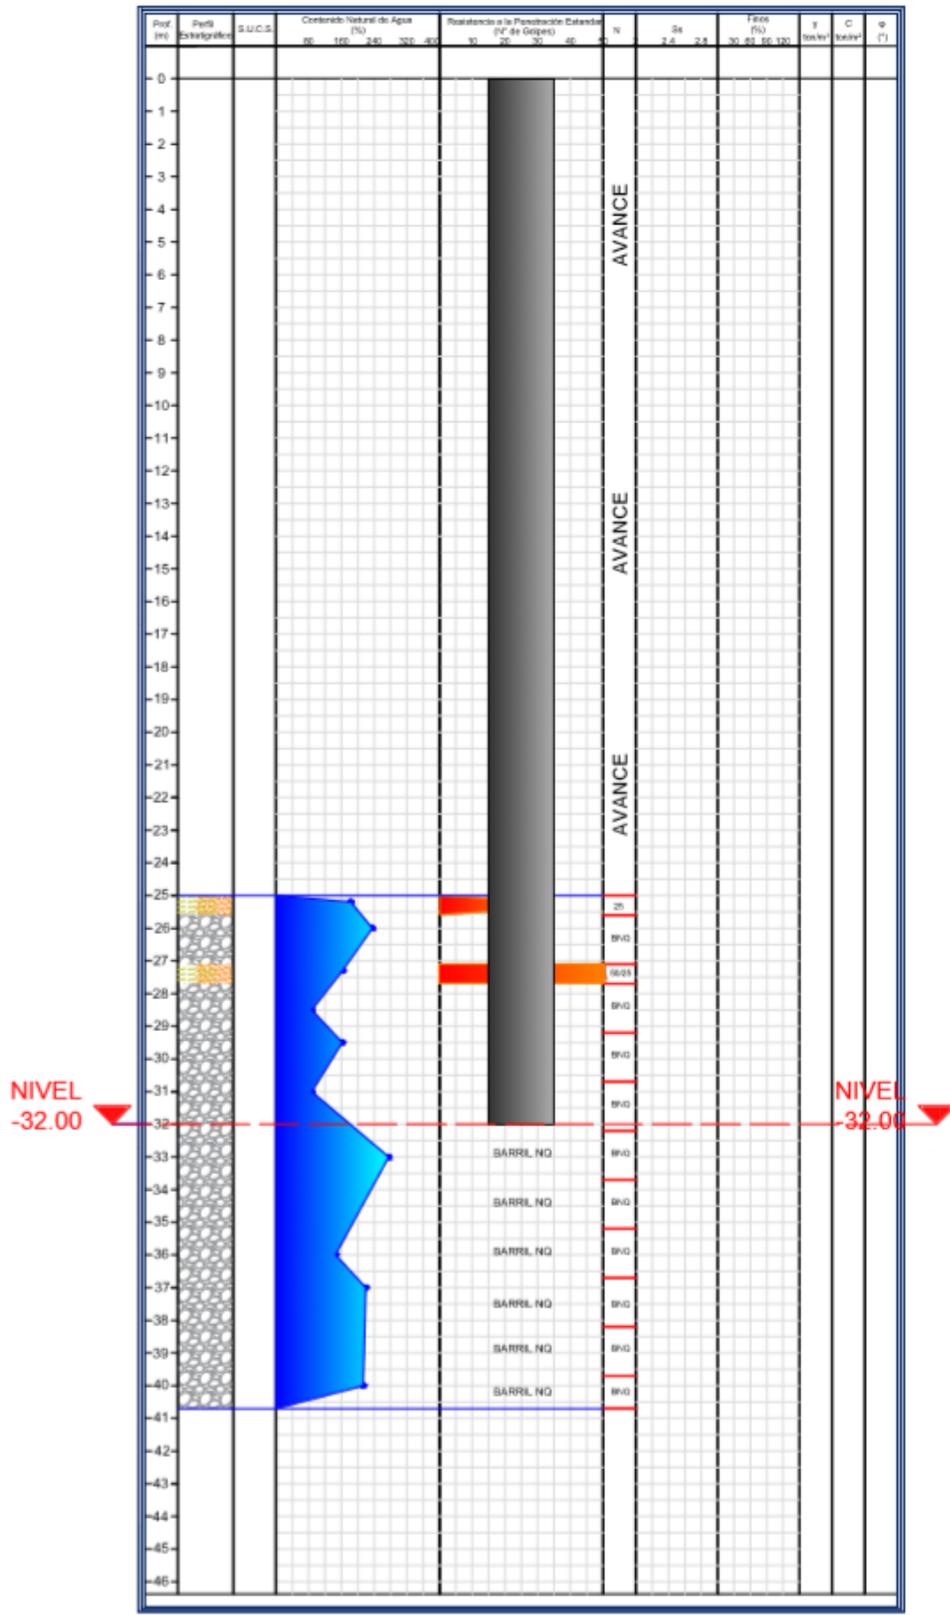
DESPLANTE DE PILA 12 (SM-4-EJE G1).
